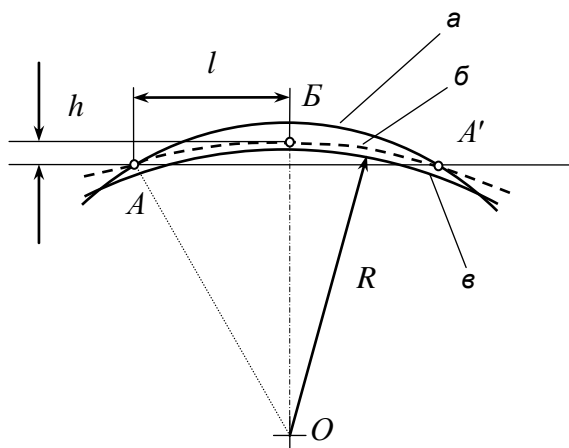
Профиль рабочей поверхности рельса: a – стандартный; b – изношенный (уплощенный); v – восстановленный рельсошлифованном; l – полуширина дорожки катания бандажа колеса по рельсу; h – высота сегмента дуги окружности профиля рельса
